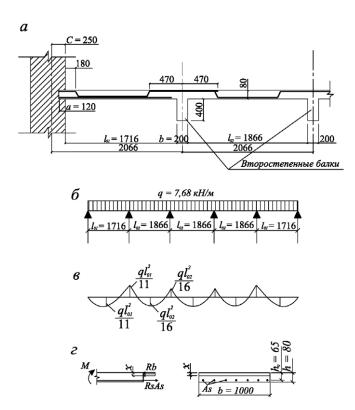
К расчету неразрезной монолитной плиты: a — расчетные пролеты и схема армирования;  $\delta$  — расчетная схема;  $\epsilon$  — эпюра изгибающих моментов;  $\epsilon$  — расчетное сечение плиты
